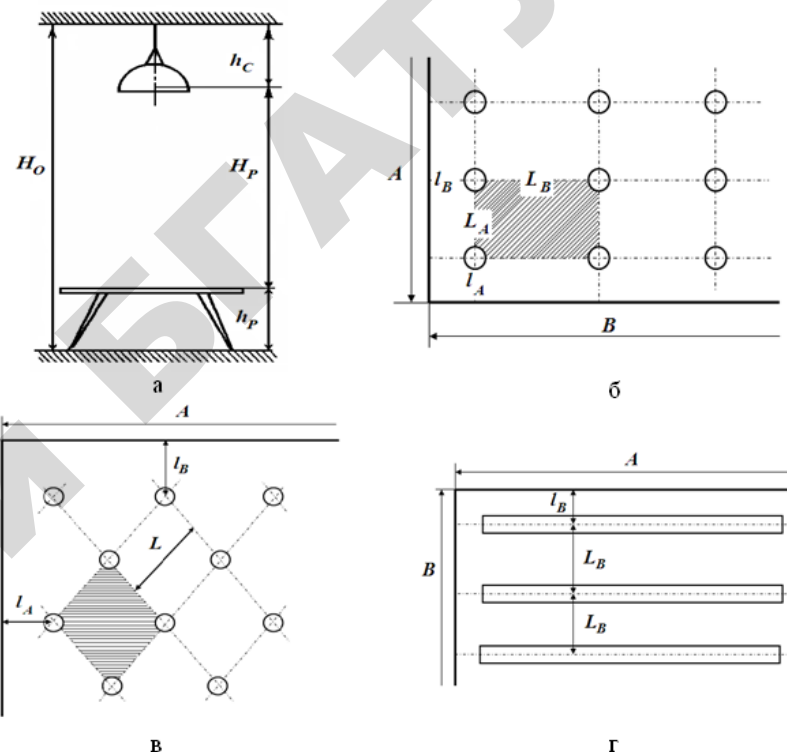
Варианты размещения светильников: а — в разрезе; б, в, г — в плане помещения: б — по углам прямоугольников; в — по вершинам ромба; г — в линию (для светильников с люминесцентными лампами)
